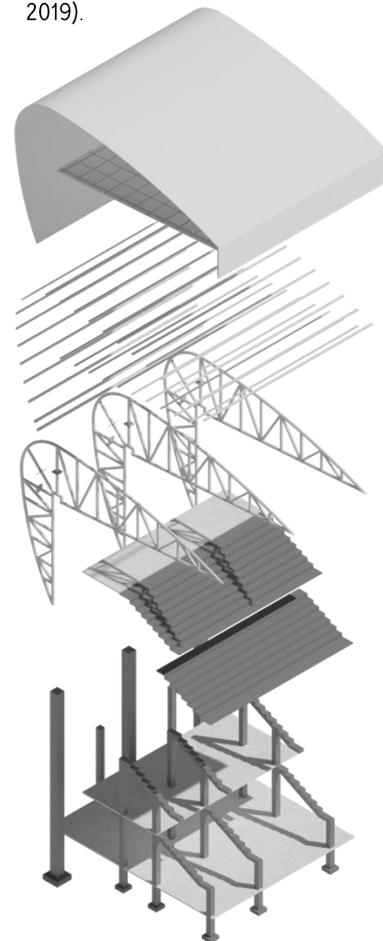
Axometría de estructura de Estadio. Elaboración propia, (marzo 2019).
